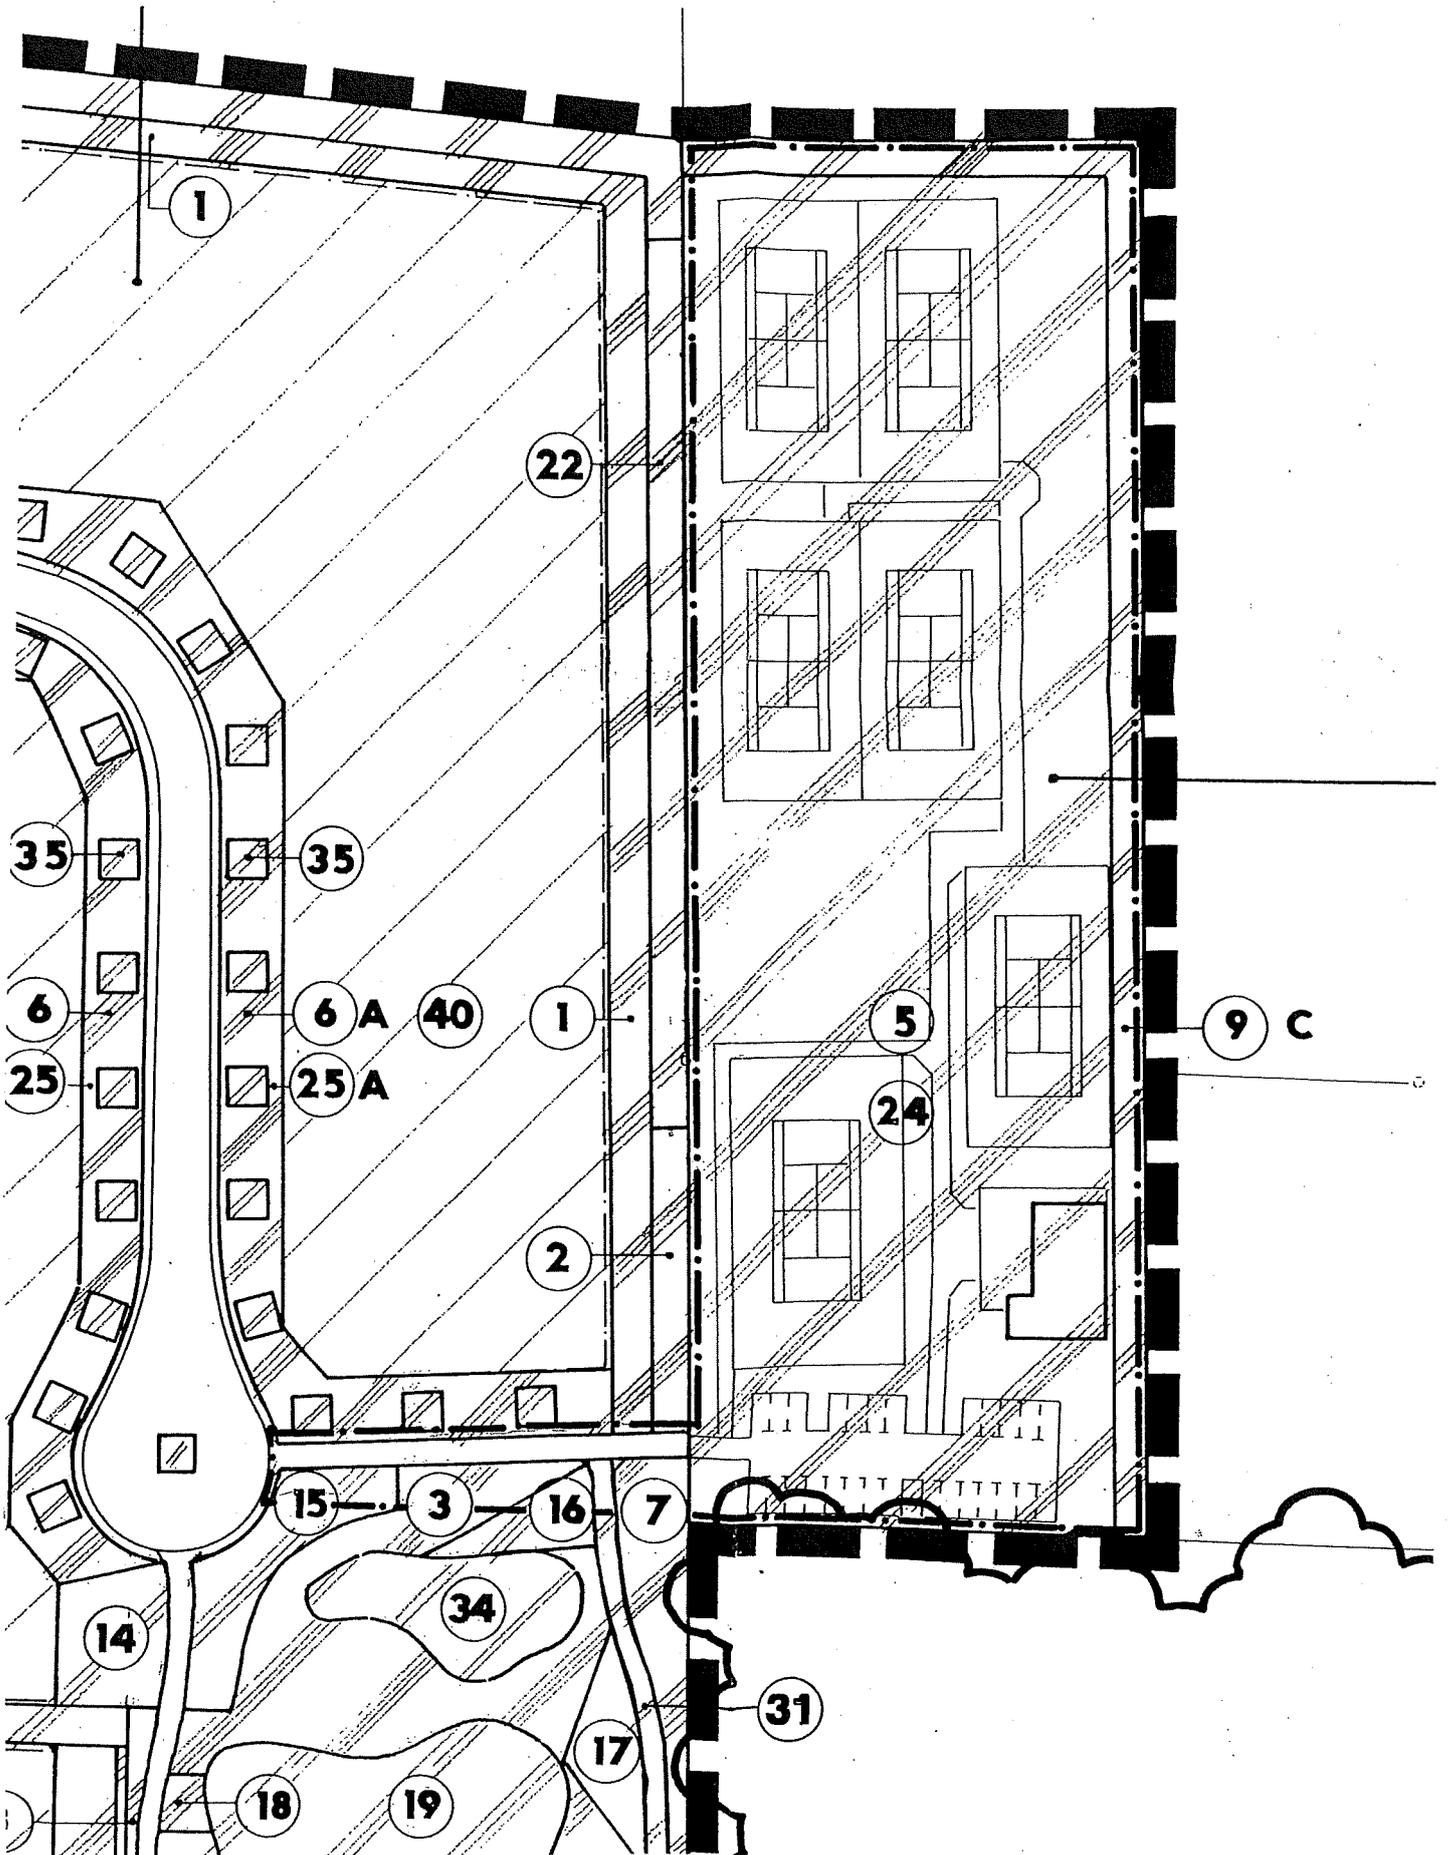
Bewertung Bestands- und Zielplan im GOP zum B-Plan Nr. 33 von 1989
